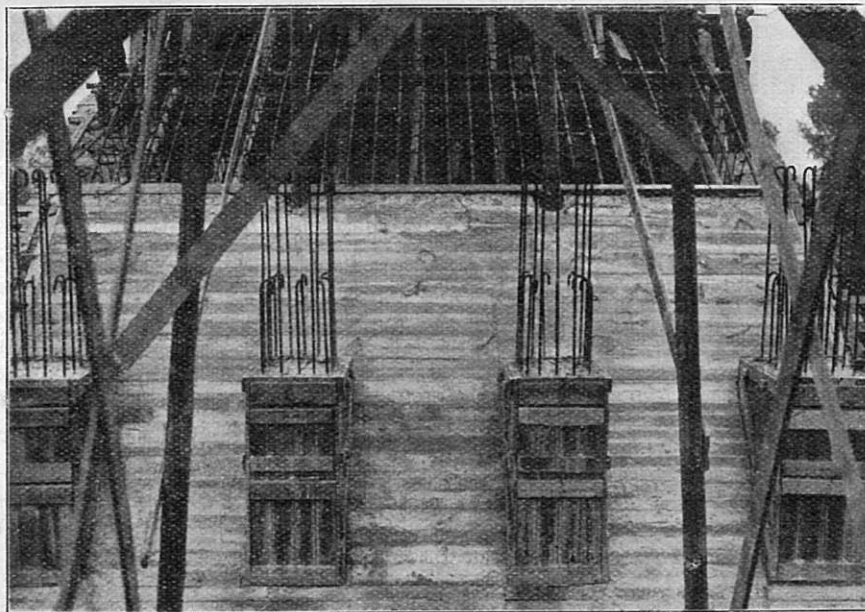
Amorces des piliers. Bétonnage d'une voûte.
